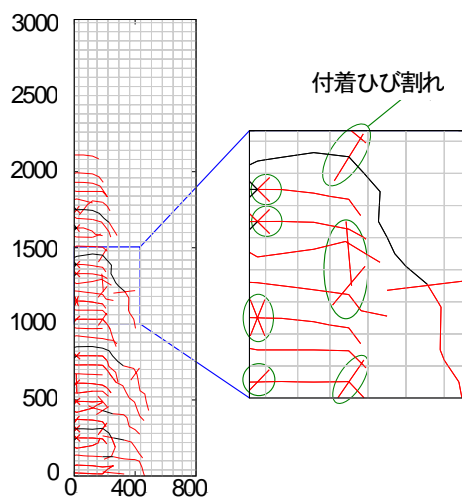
コンクリート・鉄筋間を完全固定とした場合のひび割れ性状
